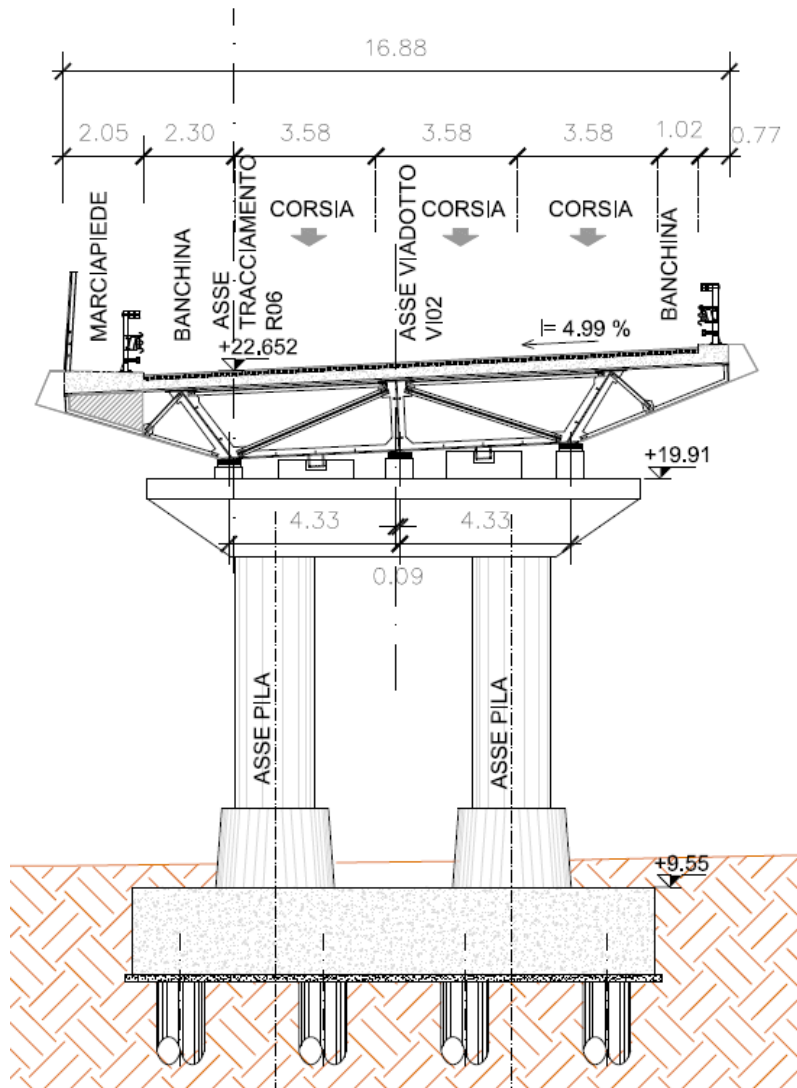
Viadotto V102 - Sezione trasversale su pila
